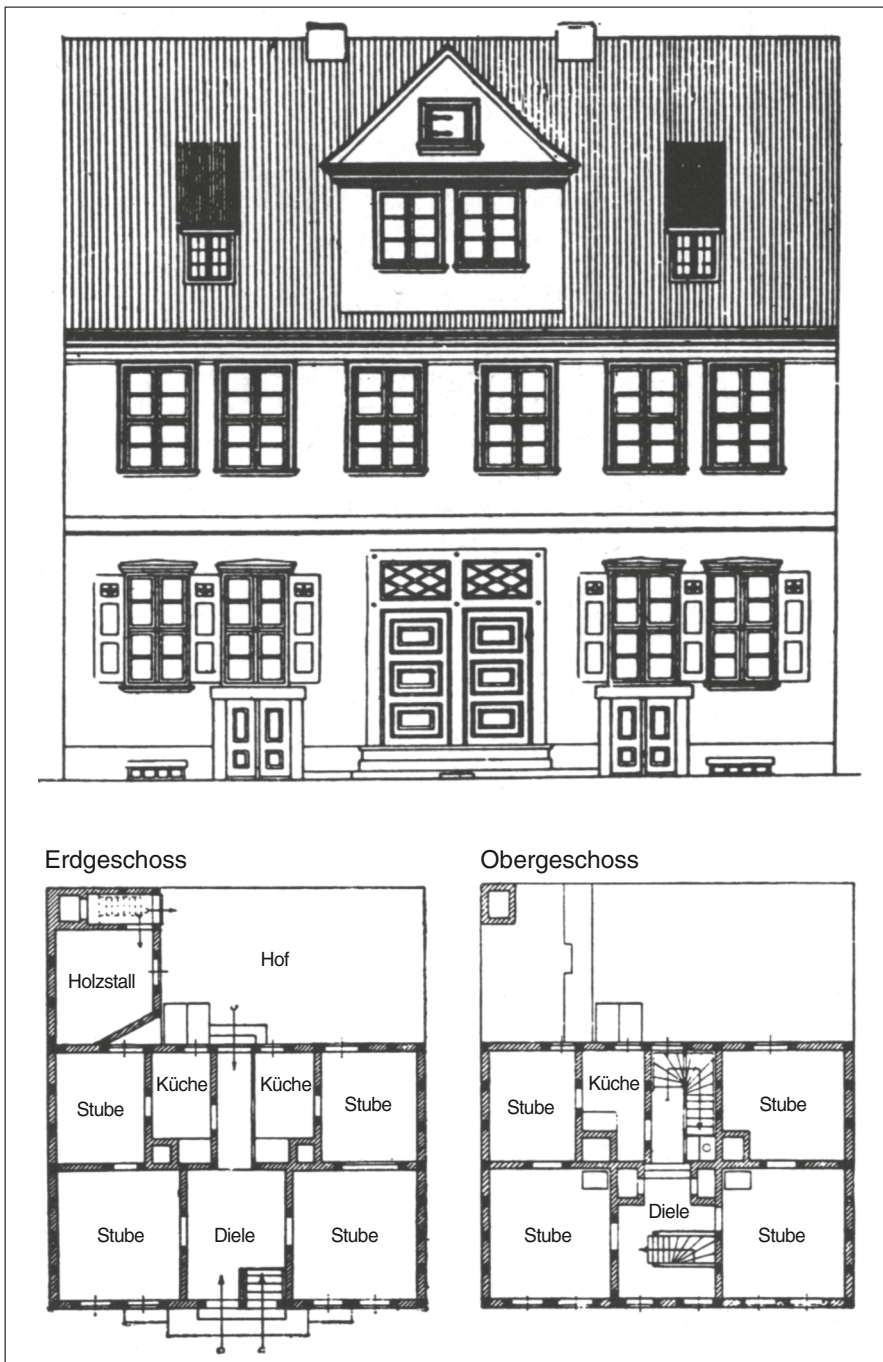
Berliner Bürgerhaus, erbaut um 1680, Straßenansicht und Grundrisse.
